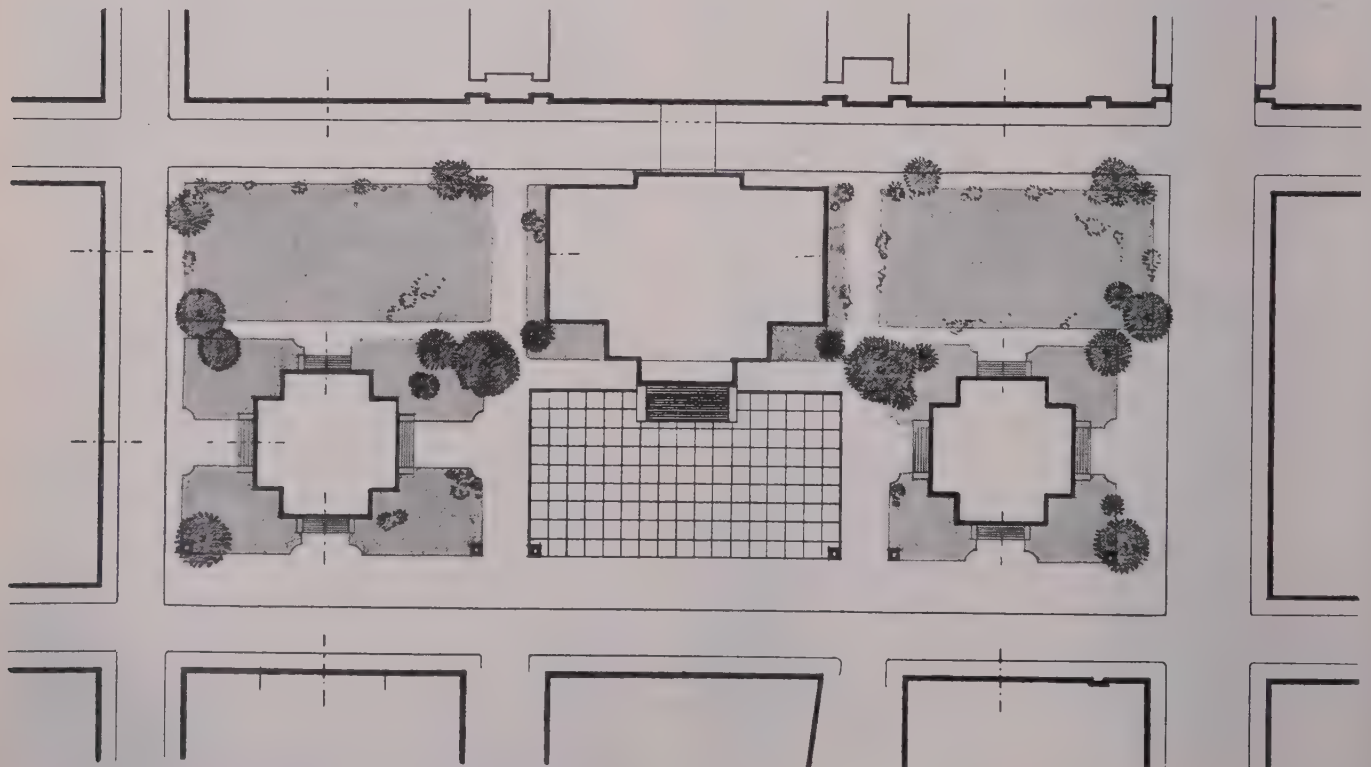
Lageplan des zukünftigen Platzes nach dem Vorschlag des Verfassers
